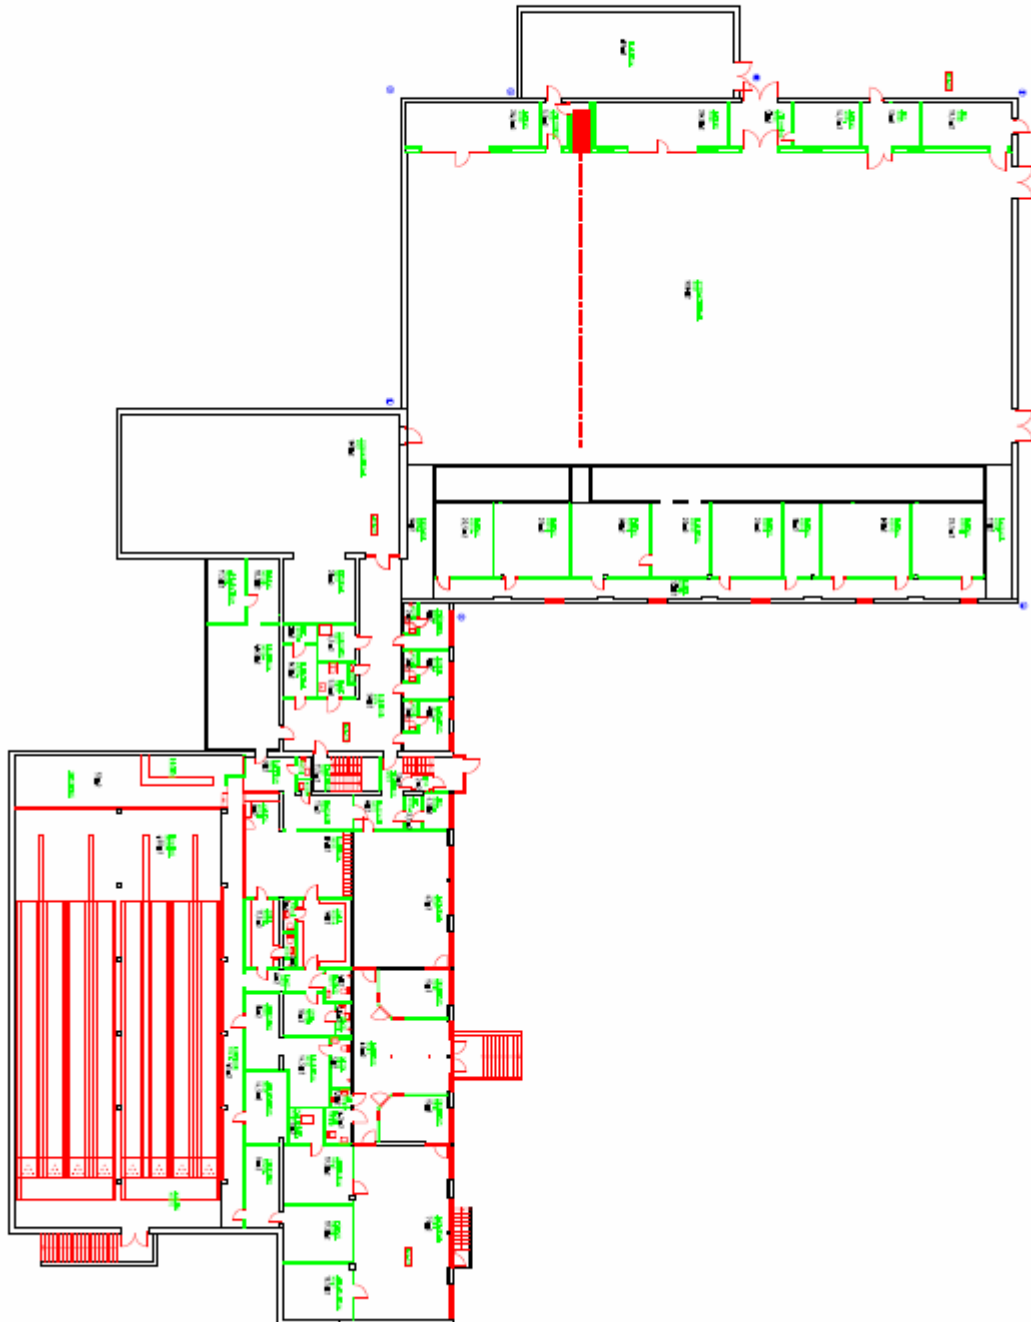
Placering av provisorisk hall, ny hall och tillfälliga paviljonger
